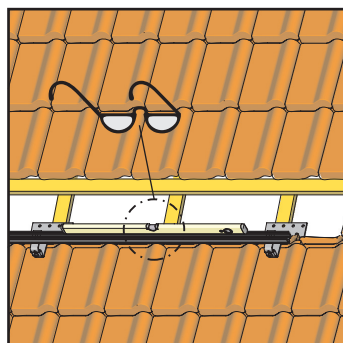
Alignez les profilés parallèlement au bord des tuiles
